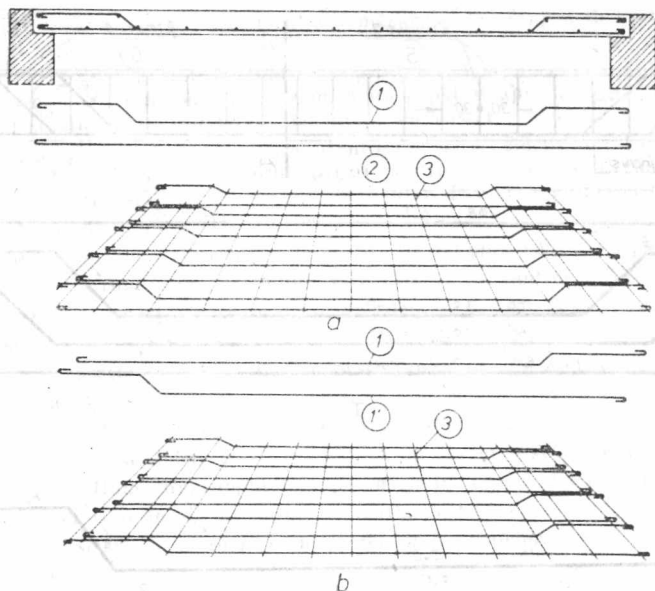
Armarea plăcilor din beton armat cu armătura de rezistență pe o singură direcție.
